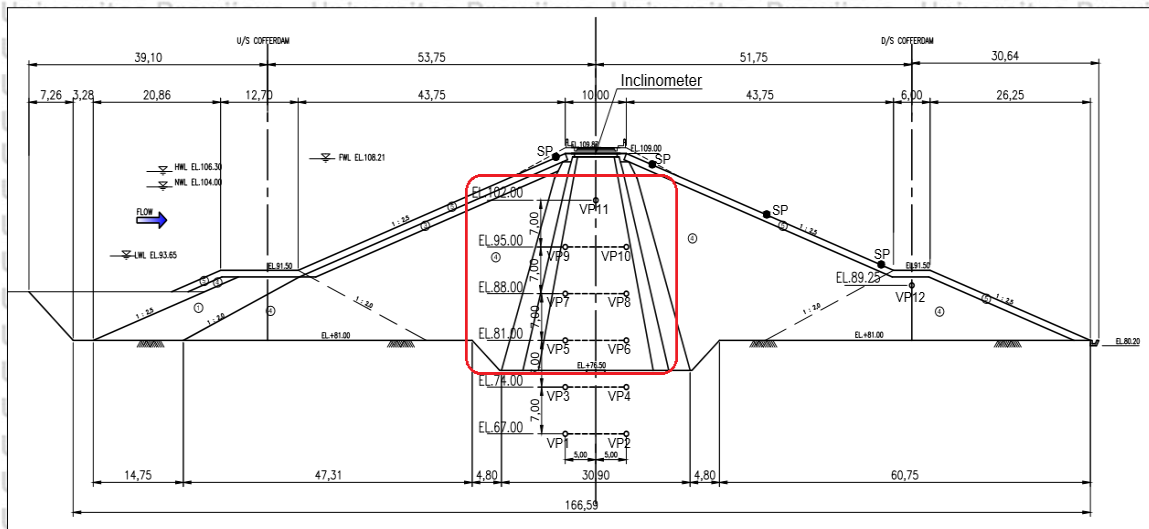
Potongan Melintang Instrumen *Vibrating Wire Piezometer* Pada Pondasi – MD.10 (STA 0+300)
